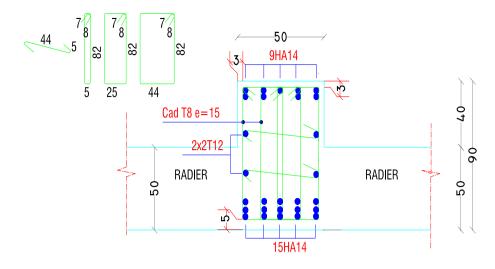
Schéma de ferraillage des nervures Sens XX.
